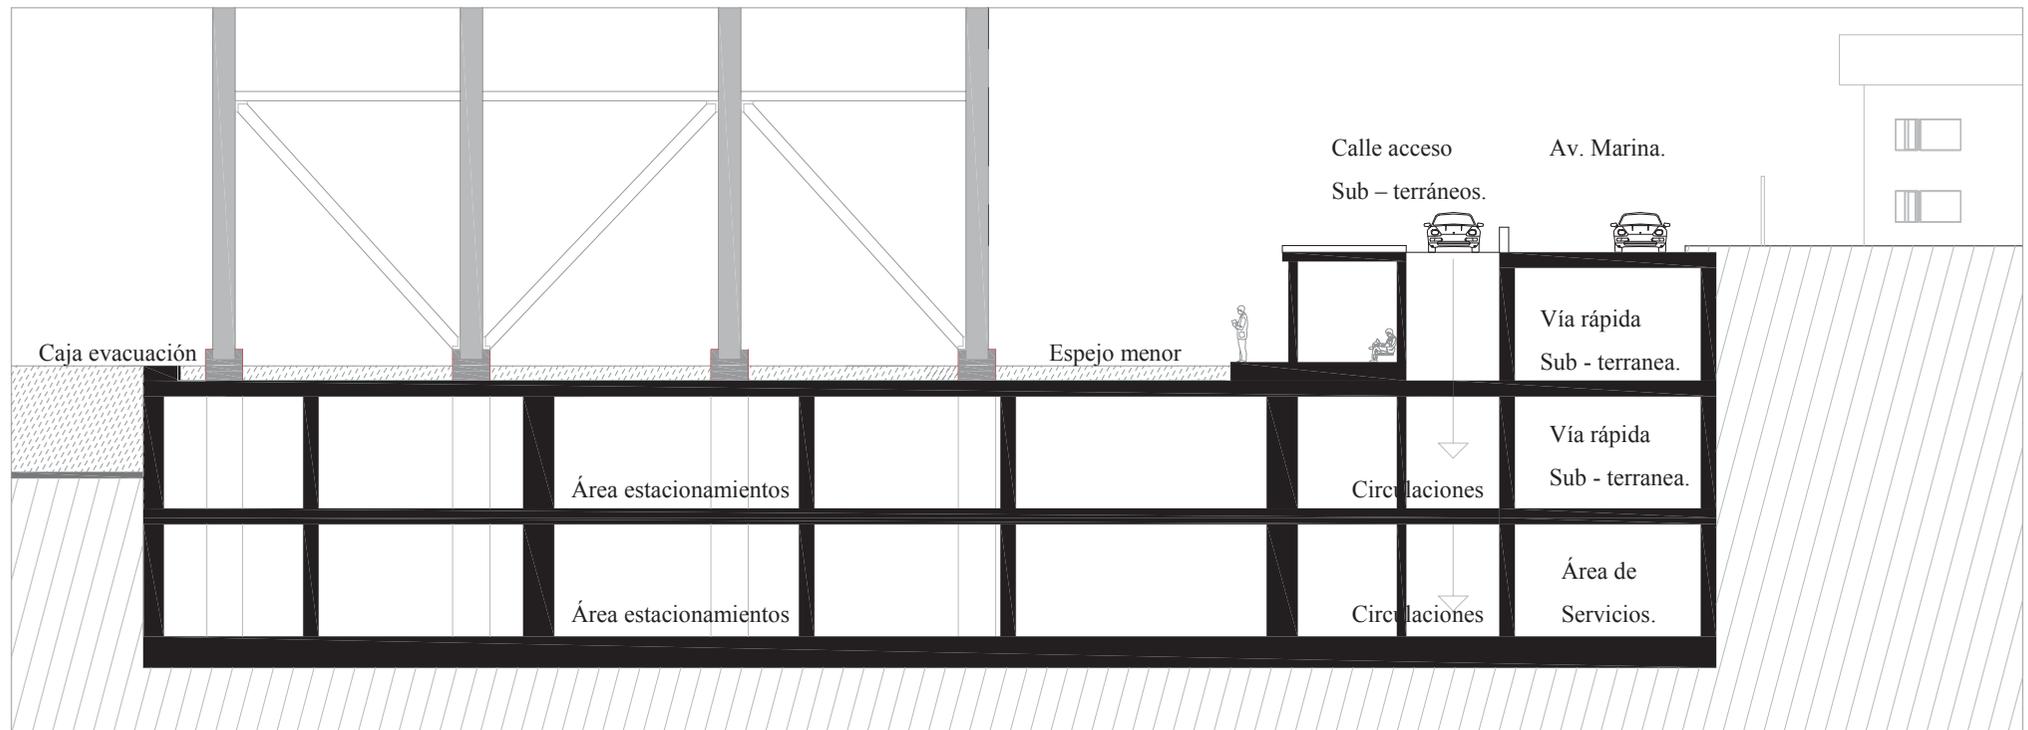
Planos Homero Latorre. Corte transversal al estero. Muestra la estructura de hormigón armado que conforma la zapata hueca de fundación, que recibe estacionamientos y áreas de desplazamientos.
